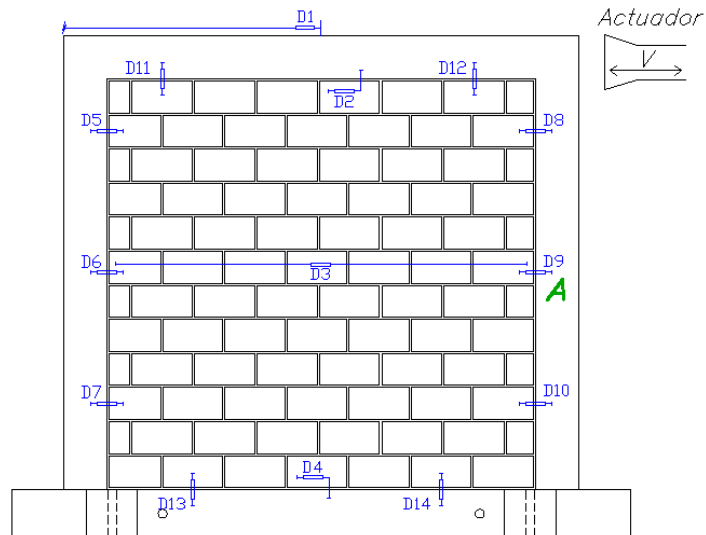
3 Detalle de la instrumentación del ensayo cíclico en el plano (Fuente: Sáenz, 2016).
